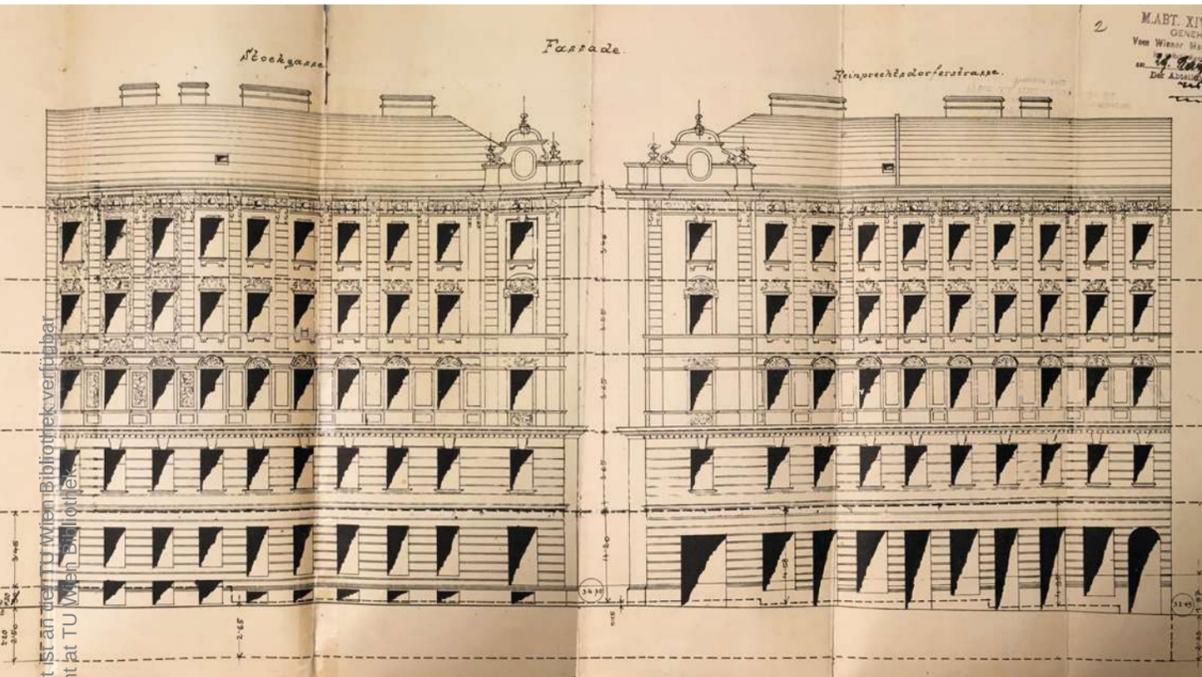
Fassaden des Eckgebäudes Reinprechtsdorfer Straße / Storkgasse
